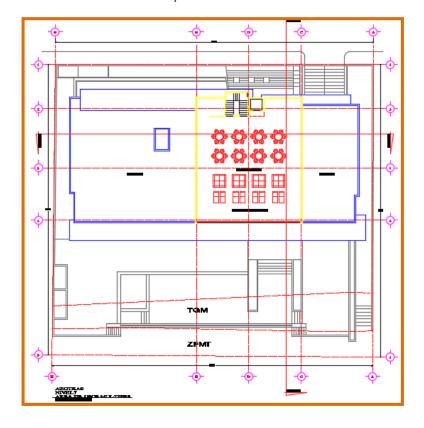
Planta Arquitectónica del Estacionamiento en Sótano
